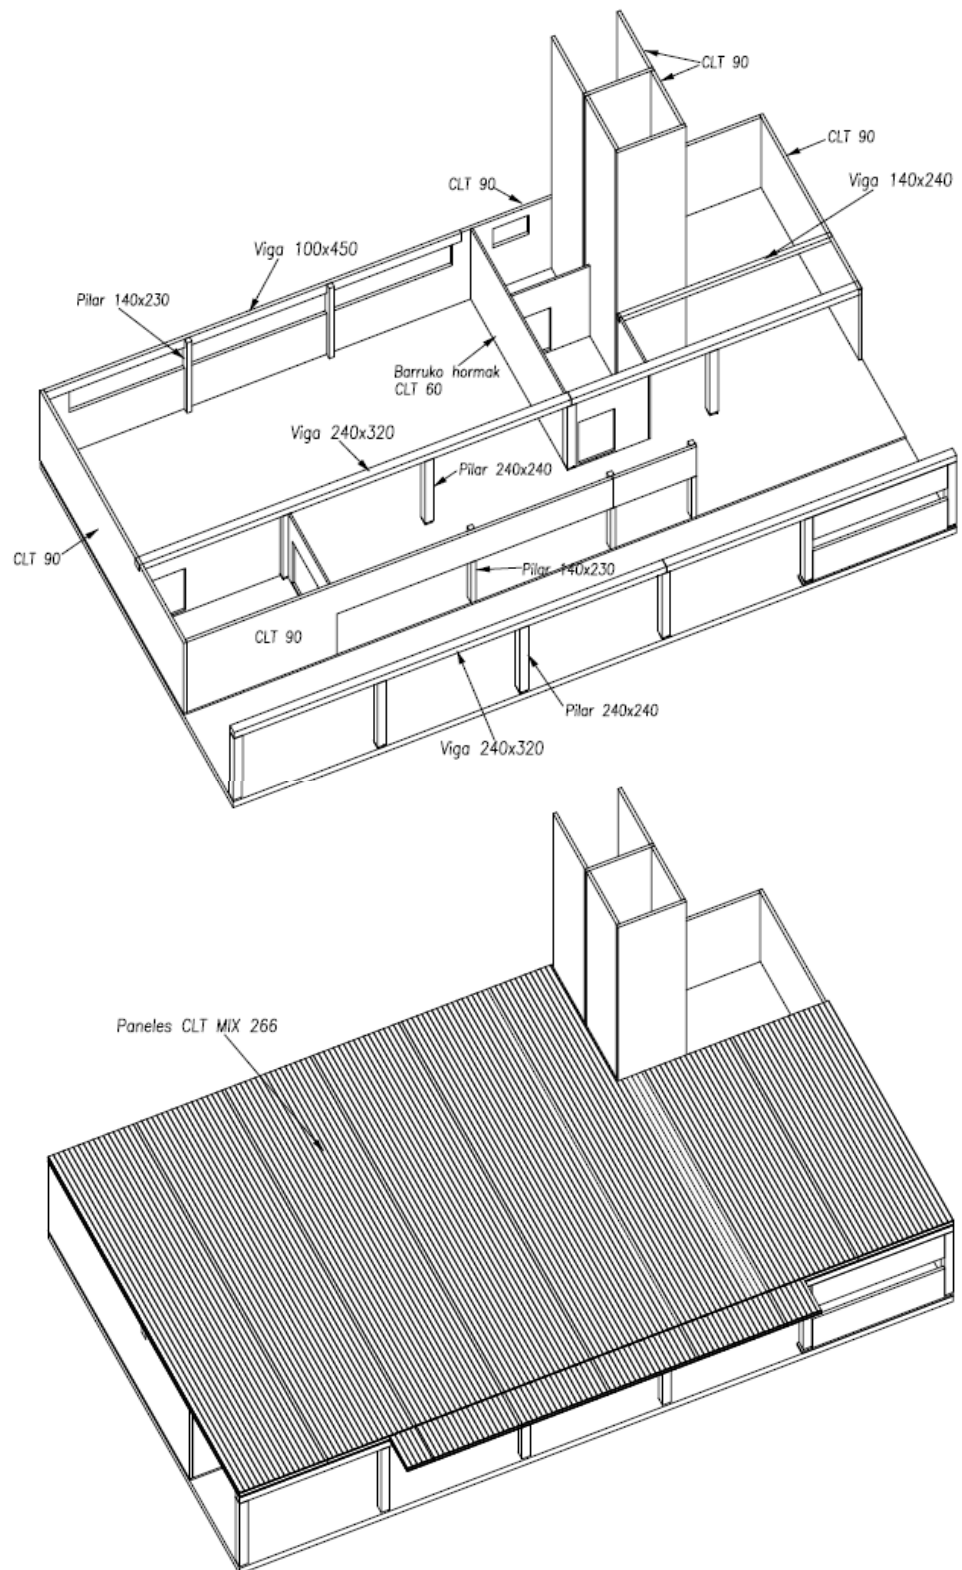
En planta baja, los pilares no entran en contacto con la solera. Se levantan sobre un perfil metálico.
